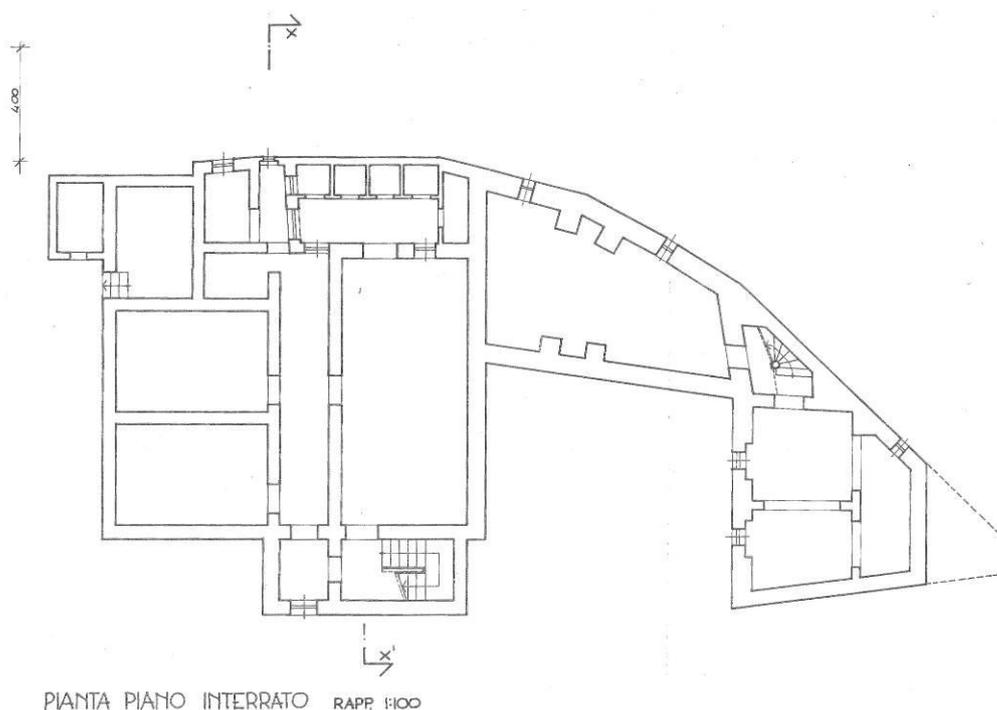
Planimetria Palazzina "M" - Piano interrato
